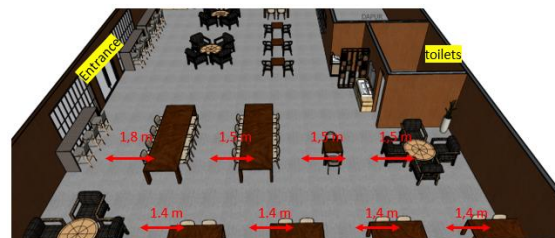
Denah Rekomendasi Desain Ruang Mensa (Sumber: dokumen penulis (2021))
